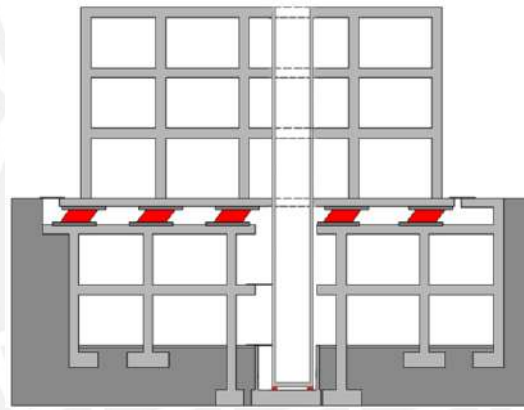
Detalle de la caja de ascensor en una estructura aislada.
